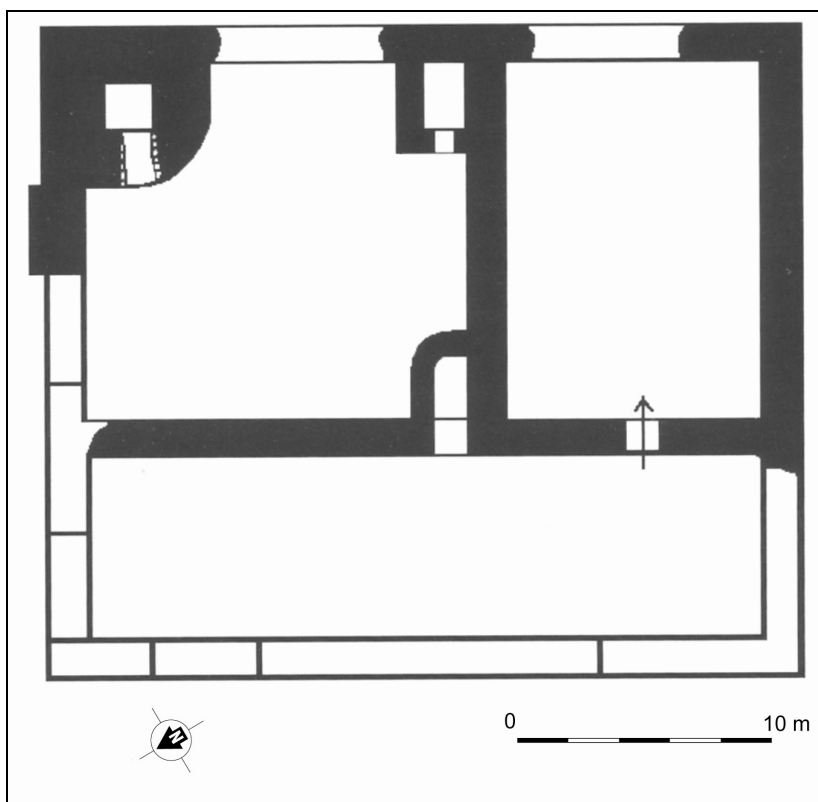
Vierraden, Burgruine (Kat.-Nr. 203), Grundriss. Nach: R. Schulz [wie Anm. 98] 77, Abb. 36.
